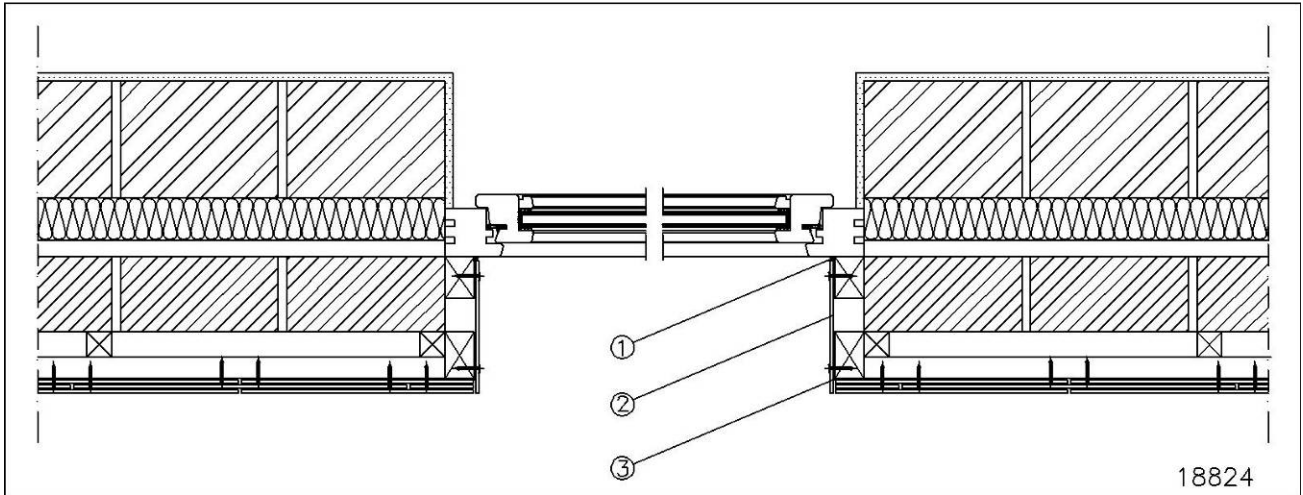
Voorbeeld inspringend raam (met dagkant) – klassieke afwerking – horizontale doorsnede
